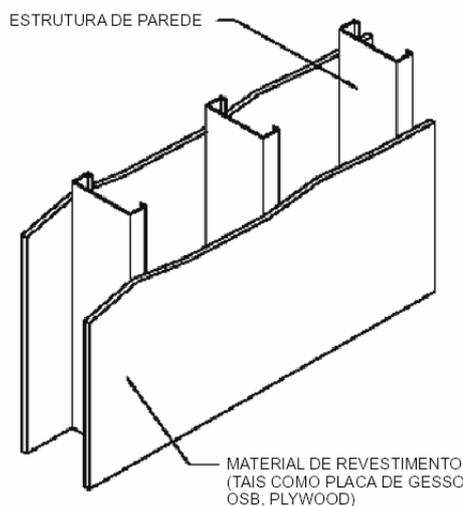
Chapa de fechamento das paredes no sistema Steel Frame
